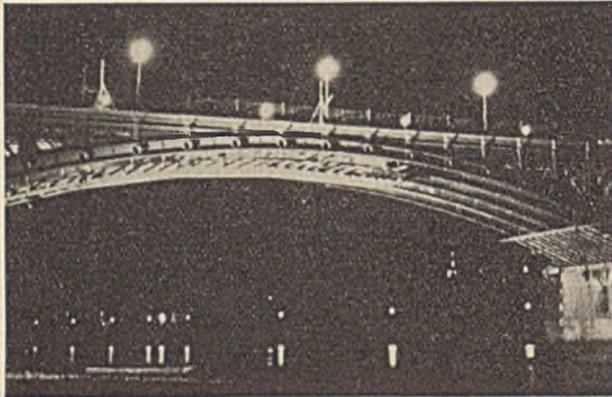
Die eingerüstete Brückenöffnung während der nächtlichen Meßdurchführung.
